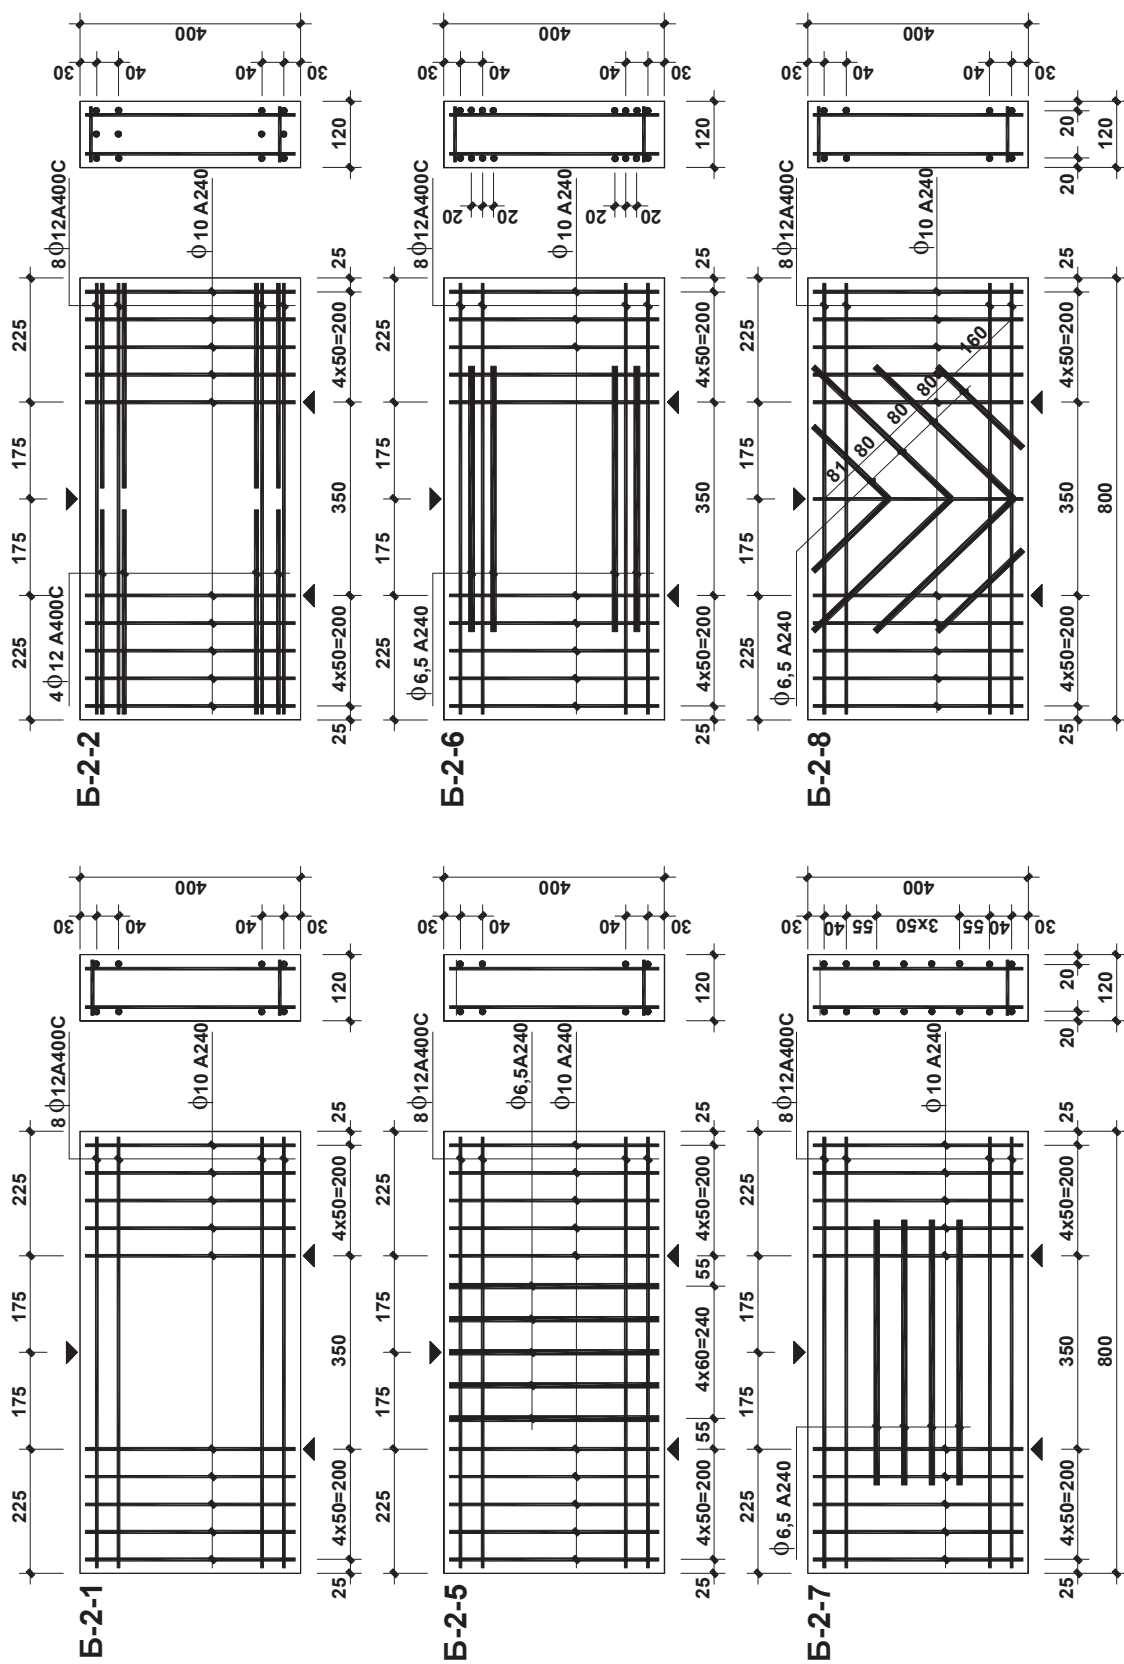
Конструкції дослідних зразків балок другої серії (похилі перерізи балок Б-2-3, Б-2-4, Б-2-5 армувалися вертикальними стержнями з різним кроком і діаметром поперечної арматури).
